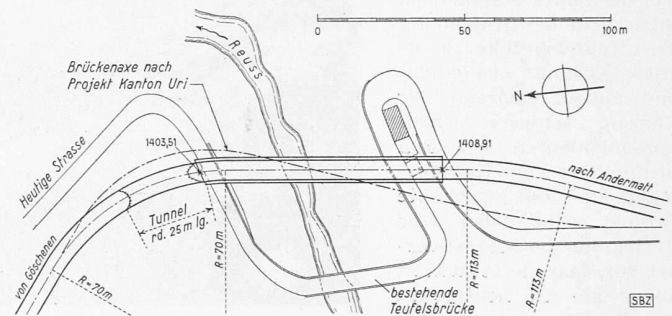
Trasse der Strasse und Lage der neuen Brücke gemäss Vorschlag der Kommission vom 8. Aug. 1952. Masstab 1:2500
